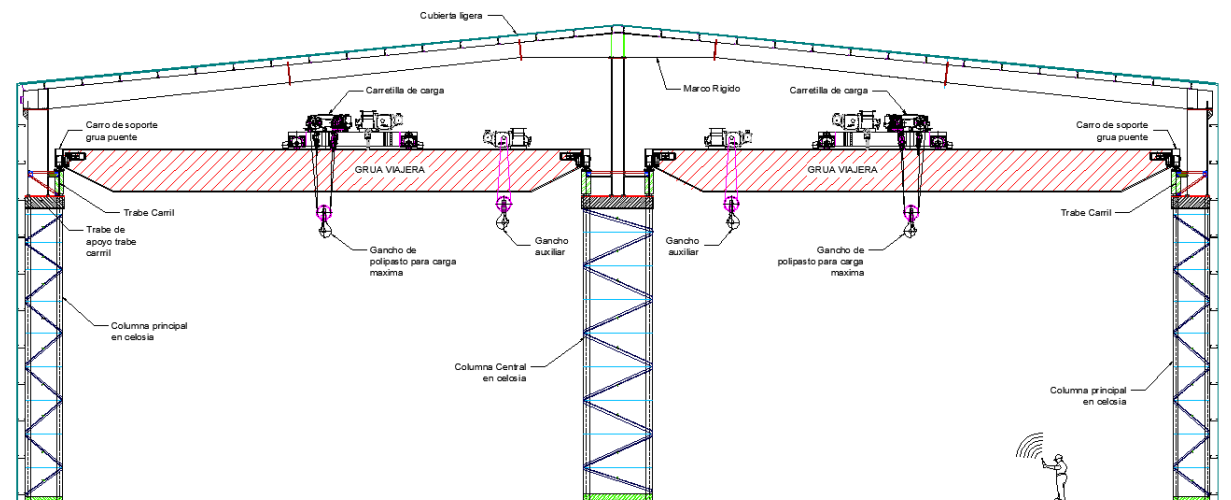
Estructura principal en dos crujeas a base de columnas de acero en celosía para trabe carril y trabe de acero de sección variable a dos aguas para la cubierta.
